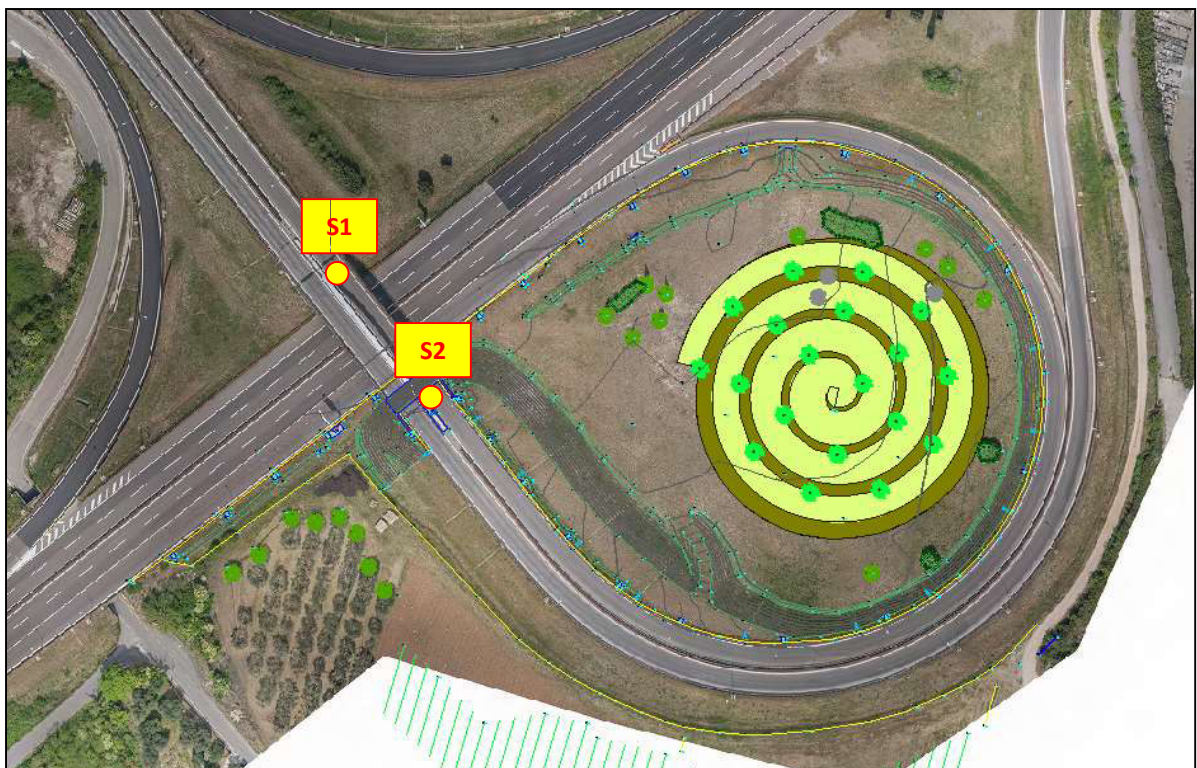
PLANIMETRIA SCHEMATICA DELL'INTERVENTO NELLO SVINCOLO DI AFFI CON UBICAZIONE DEI SONDAGGI
